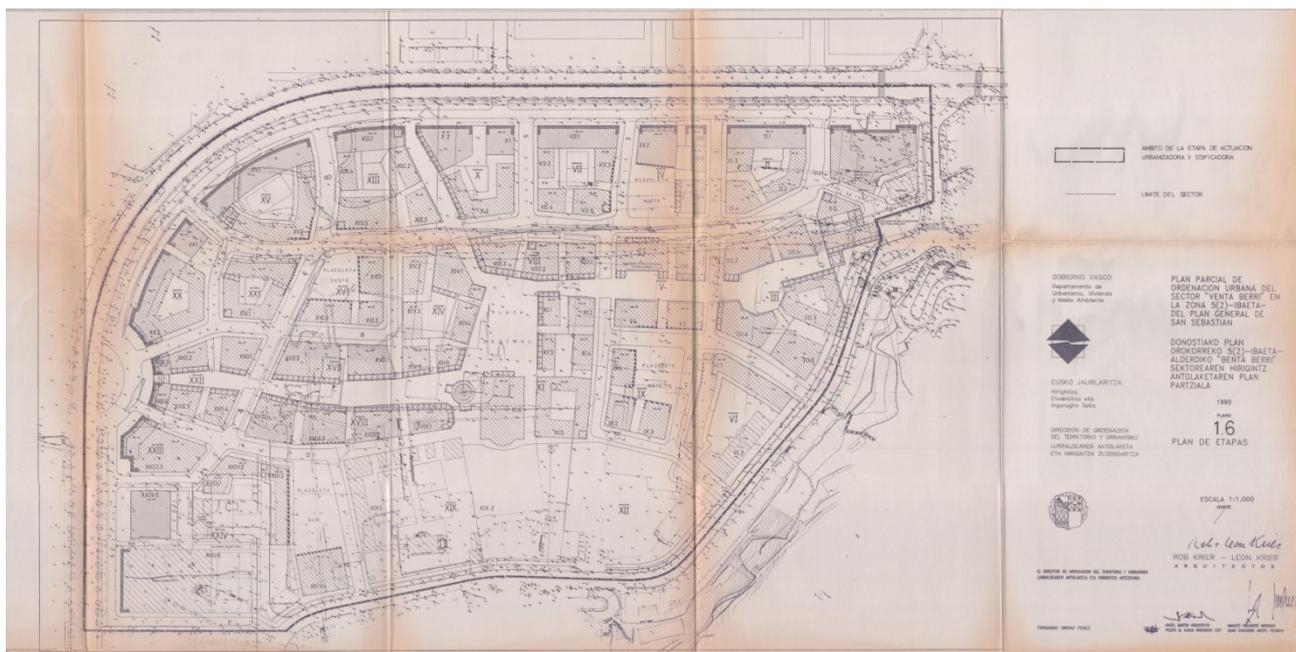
Plano 1.6 de Plan de etapas - P.P.H.K.
